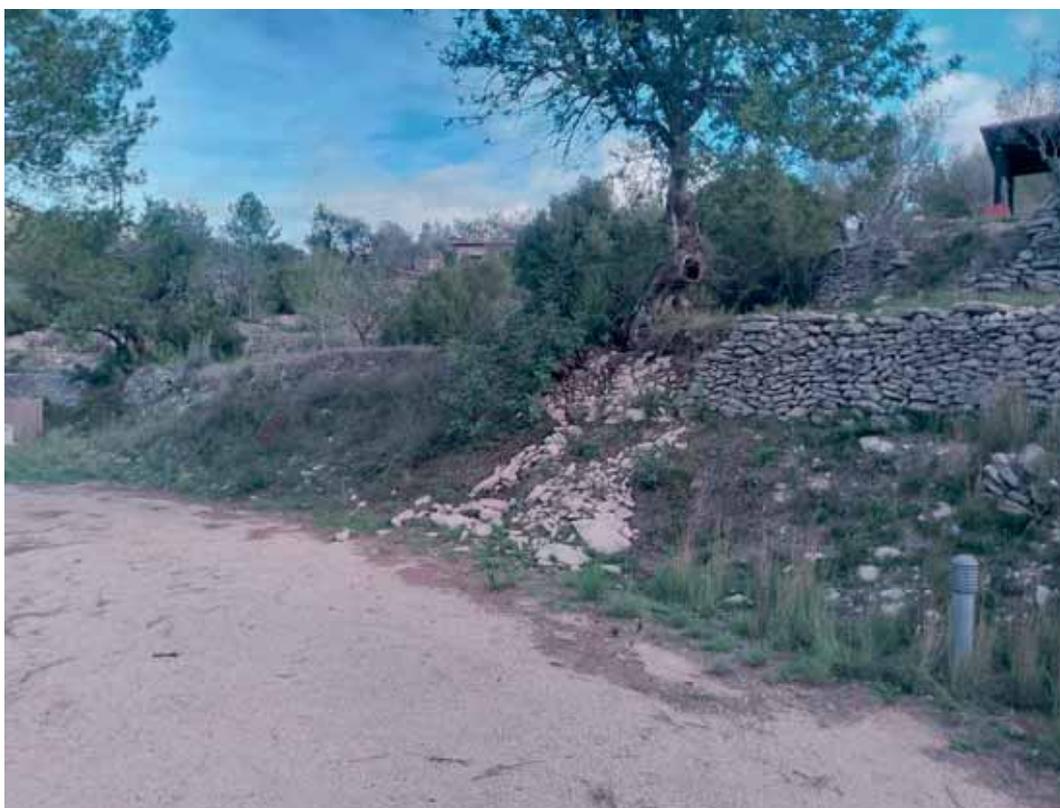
Zona aparcamiento. Detalle de tramo con pérdida de muro de sostenimiento
